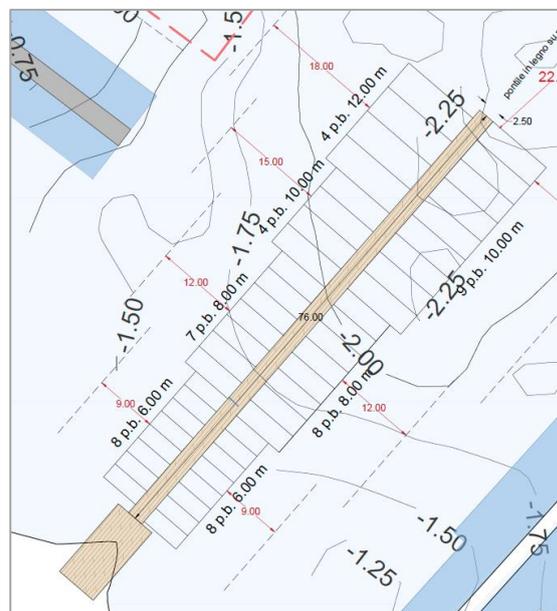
Stralcio planimetrico nuova struttura di ormeggio
